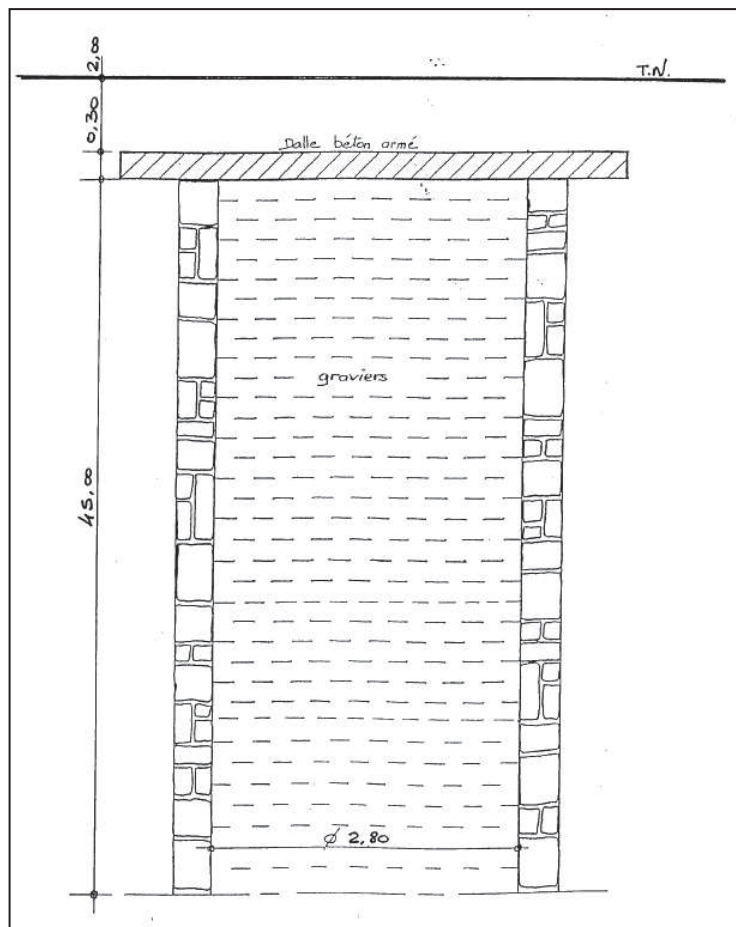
Schéma de mise en place de la dalle du puits d'aération n°2
